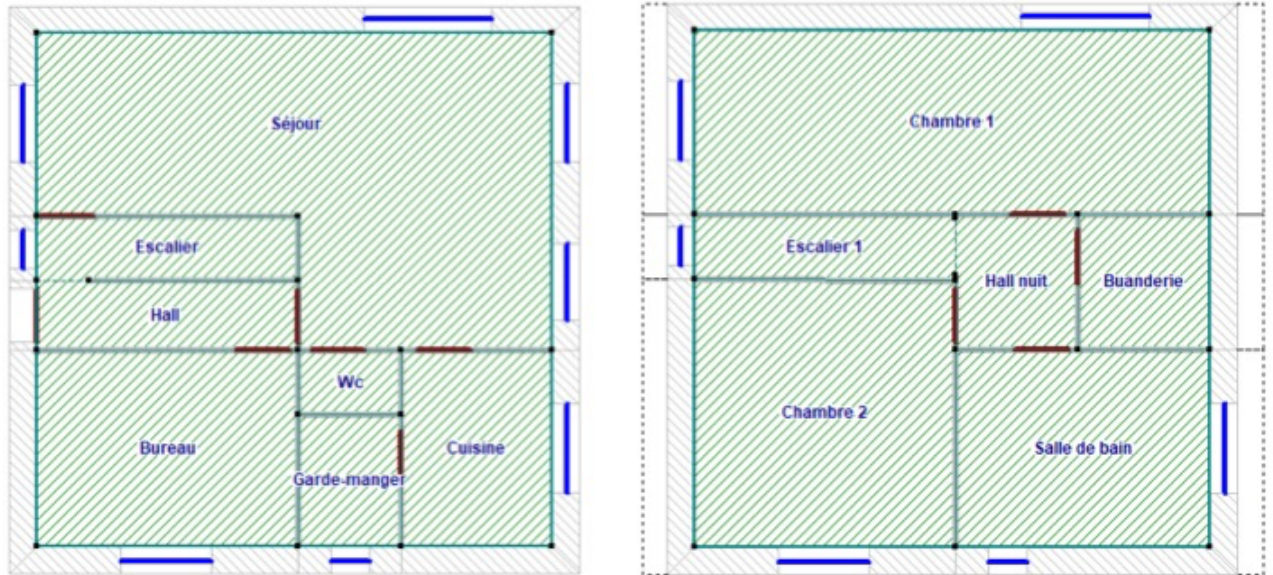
Plan 2D du bâtiment étudié - Pleiades Modeleur
